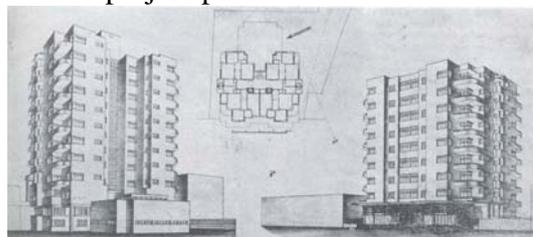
Estudo de fachadas e plantas de situação Edifício Columbus. . Fonte: *Arquitetura*, 1965, vol.42
